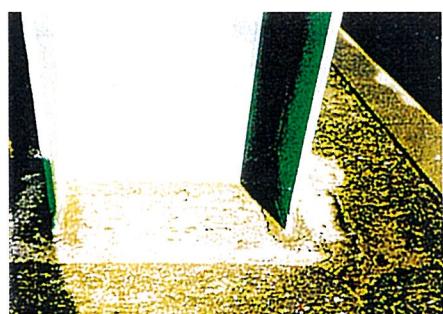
下路アーチ橋の舗装路面のひび割れ状況
